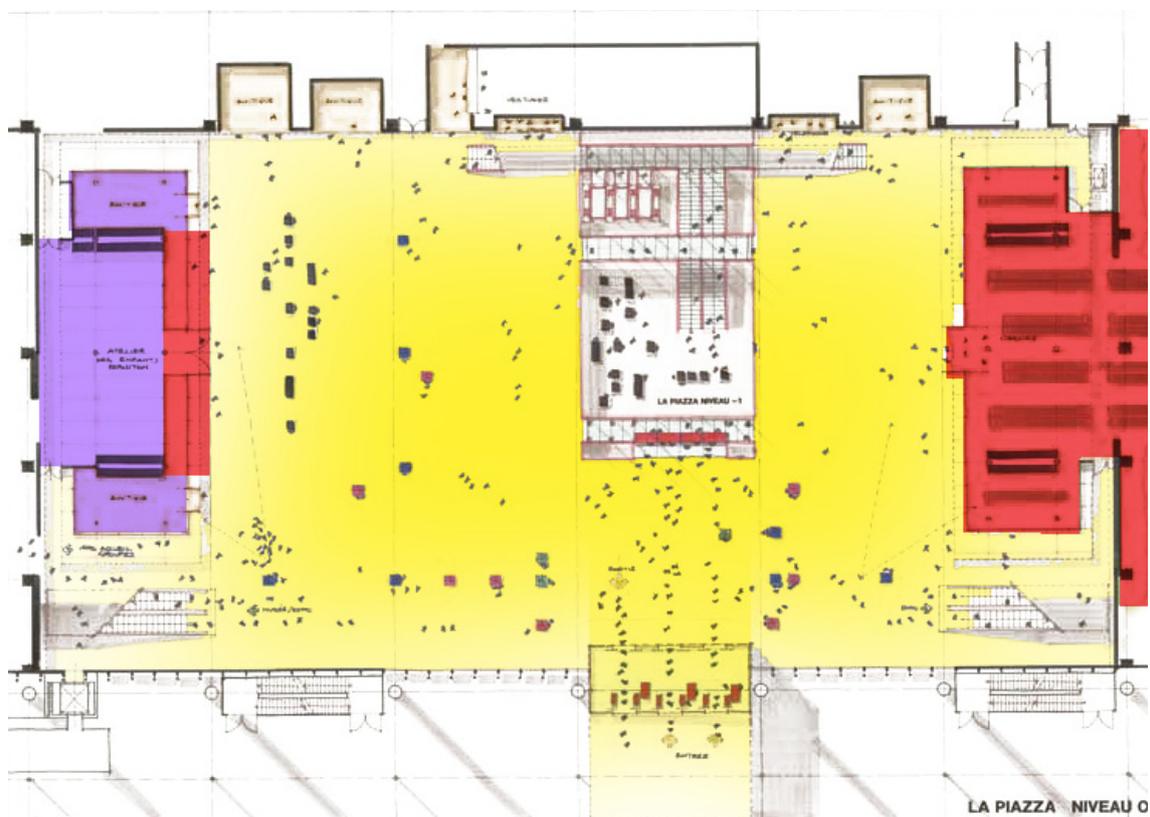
Usos planta baja. Centro Georges Pompidou.
